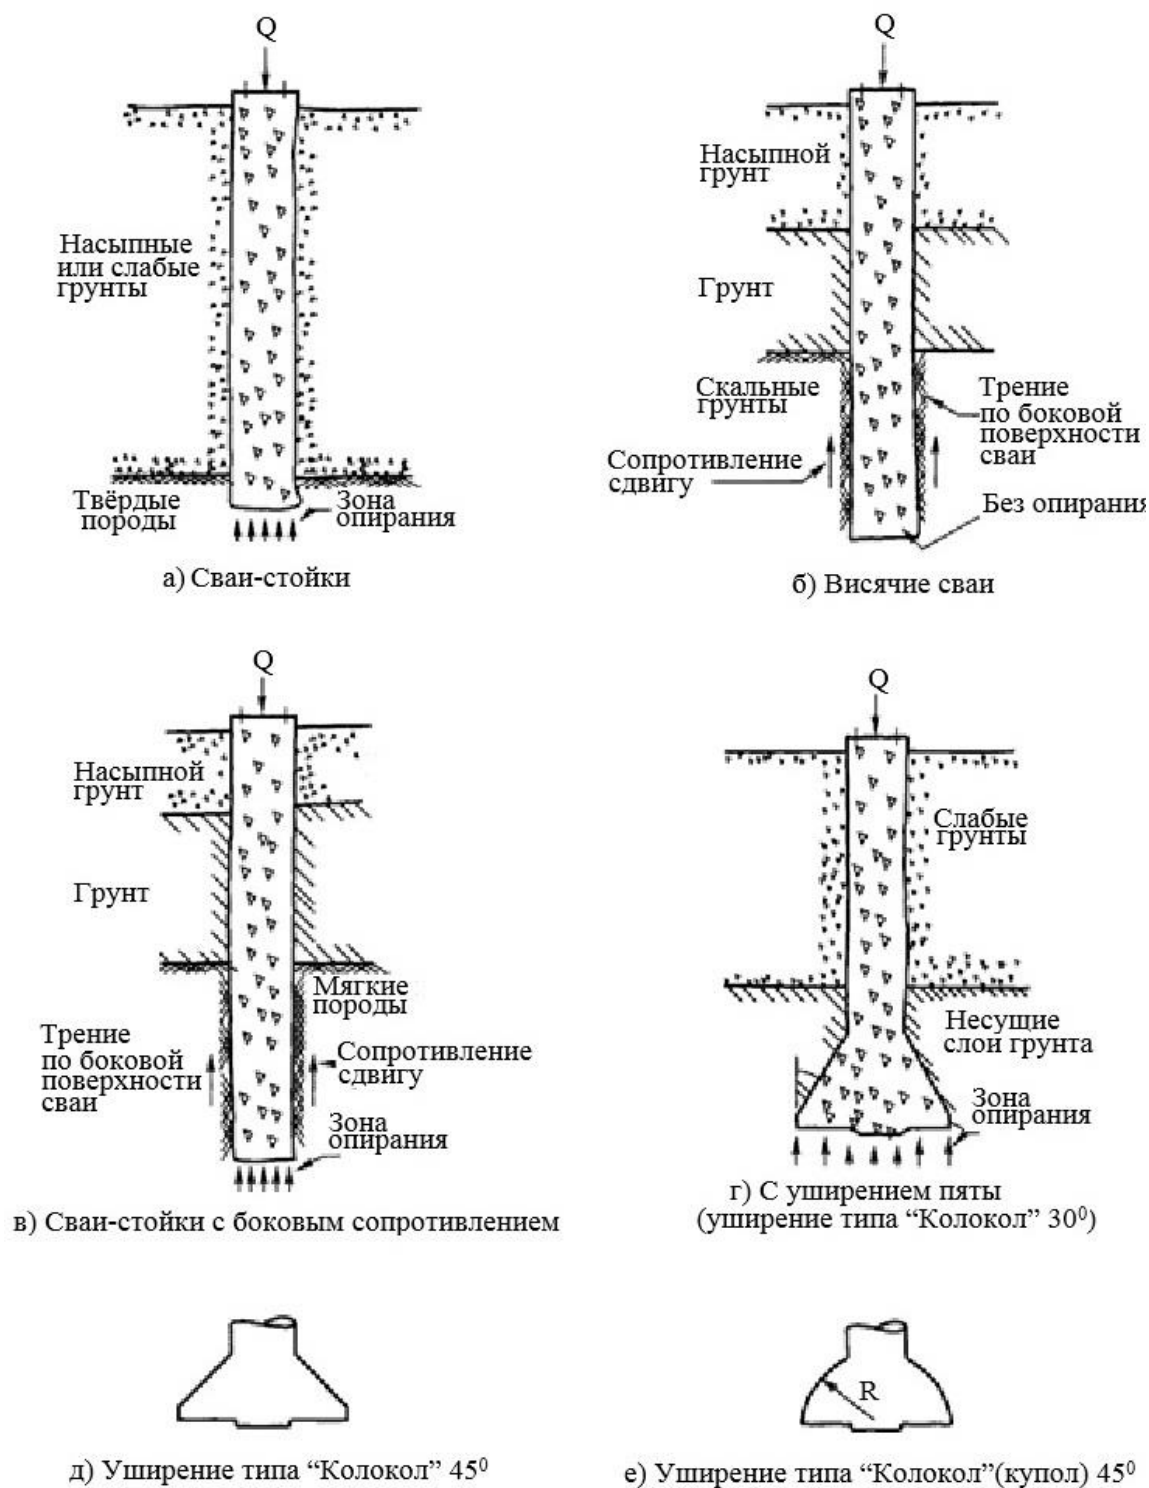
Типы буронабивных свай по способу опирания в грунтовом основании
